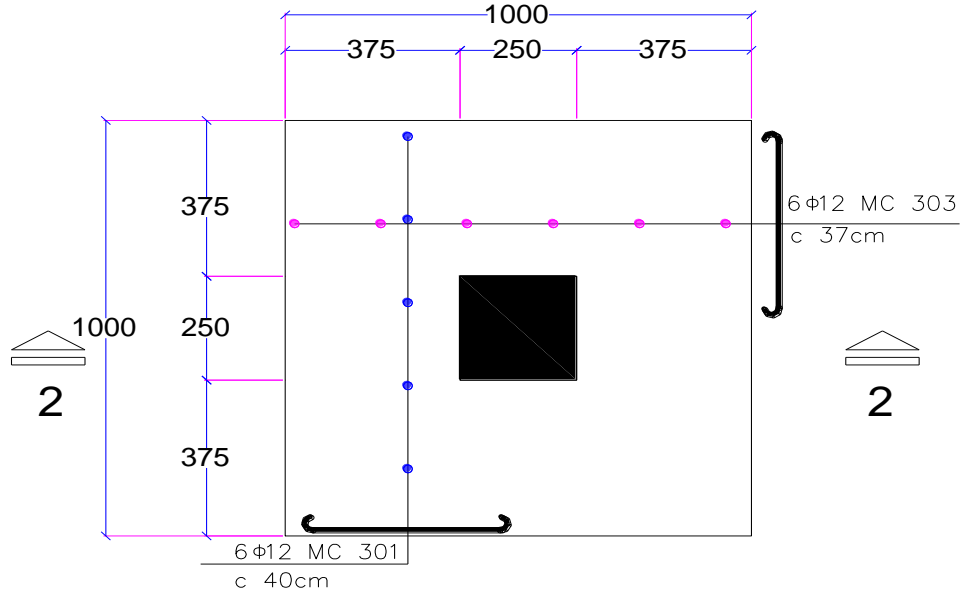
Se describe la planta típica de las zapatas, ubicación del acero de refuerzo y sus dimensiones.
